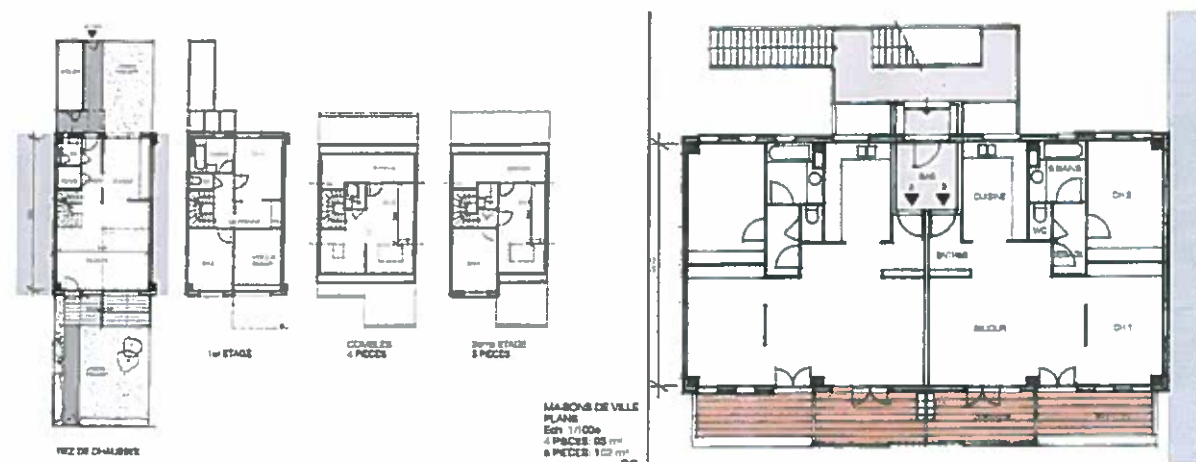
Plan type des maisons de ville et plan des logements de l'immeuble collectif locatif
